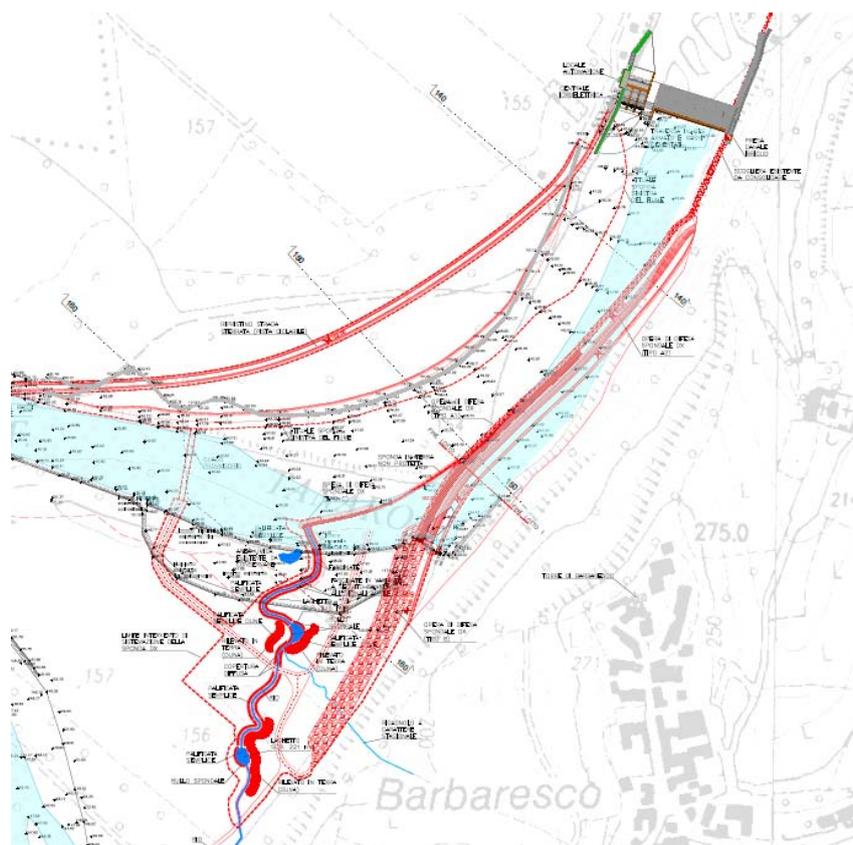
Planimetria delle opere già autorizzate (in rosso) sovrapposte al progetto in esame.
